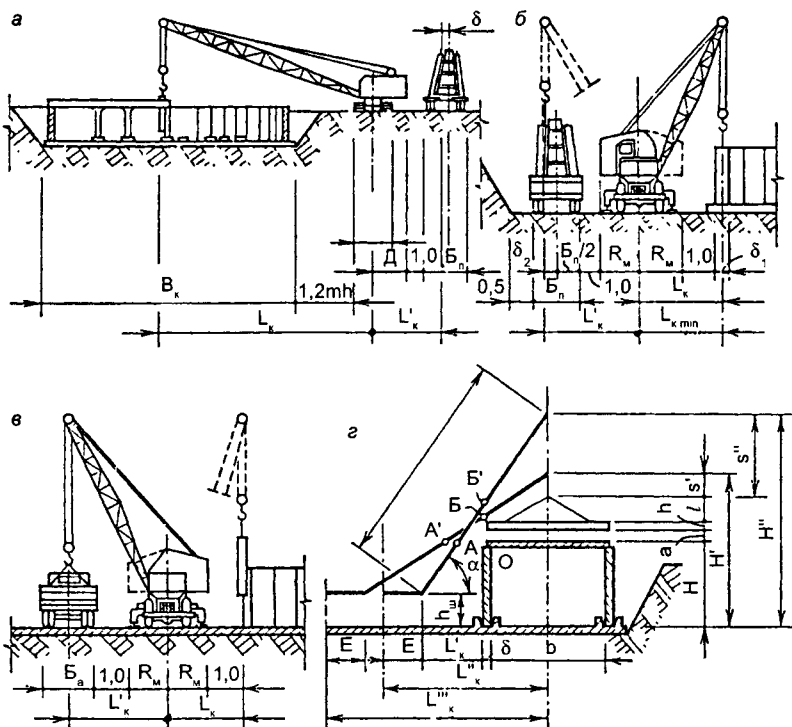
Схемы определения вылета крюка крана и высоты его подъема при монтаже емкостных сооружений:
